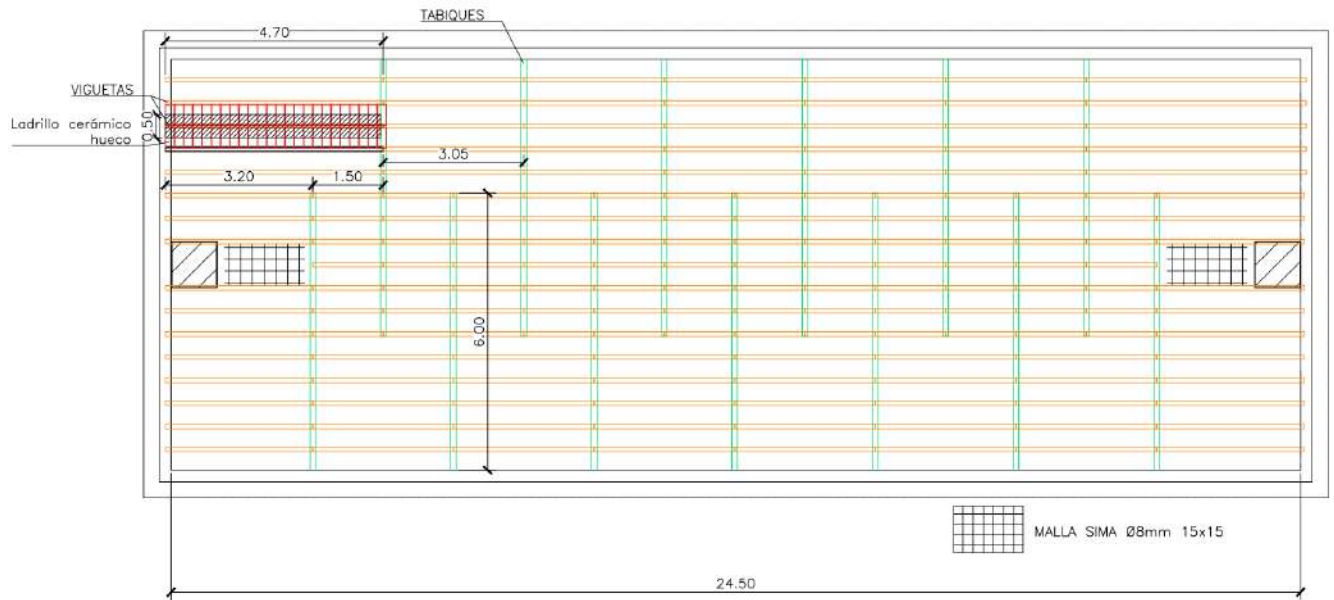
Elementos estructurales de la nueva cisterna a dimensionar – Fuente de elaboración propia
